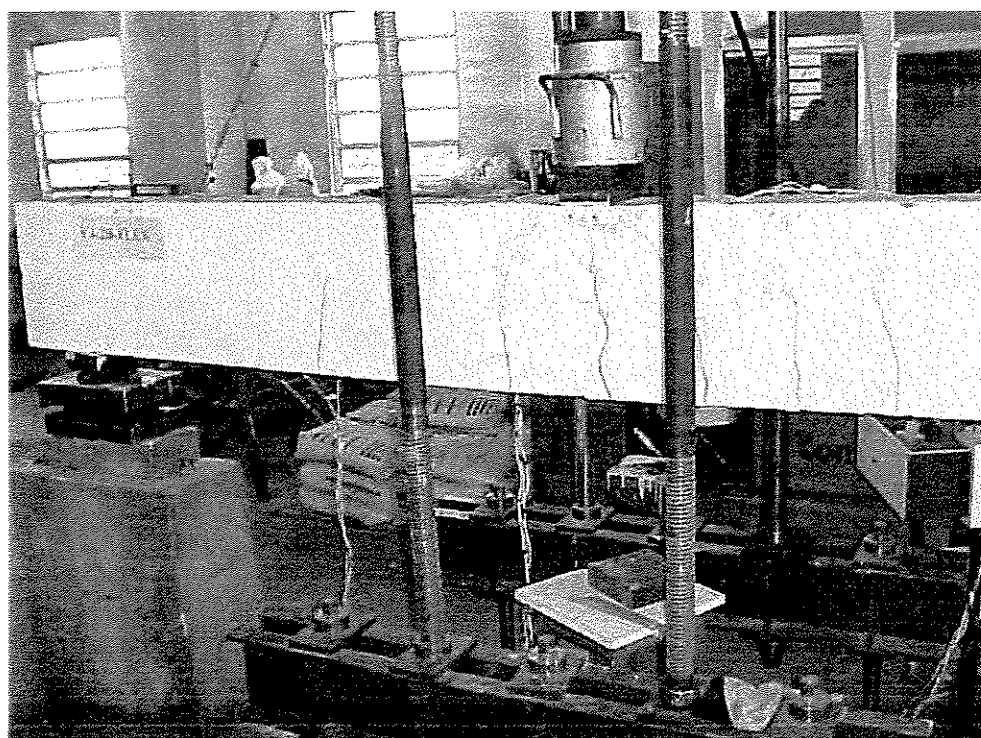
VIGA 2BL-FL APÓS ENSAIO
